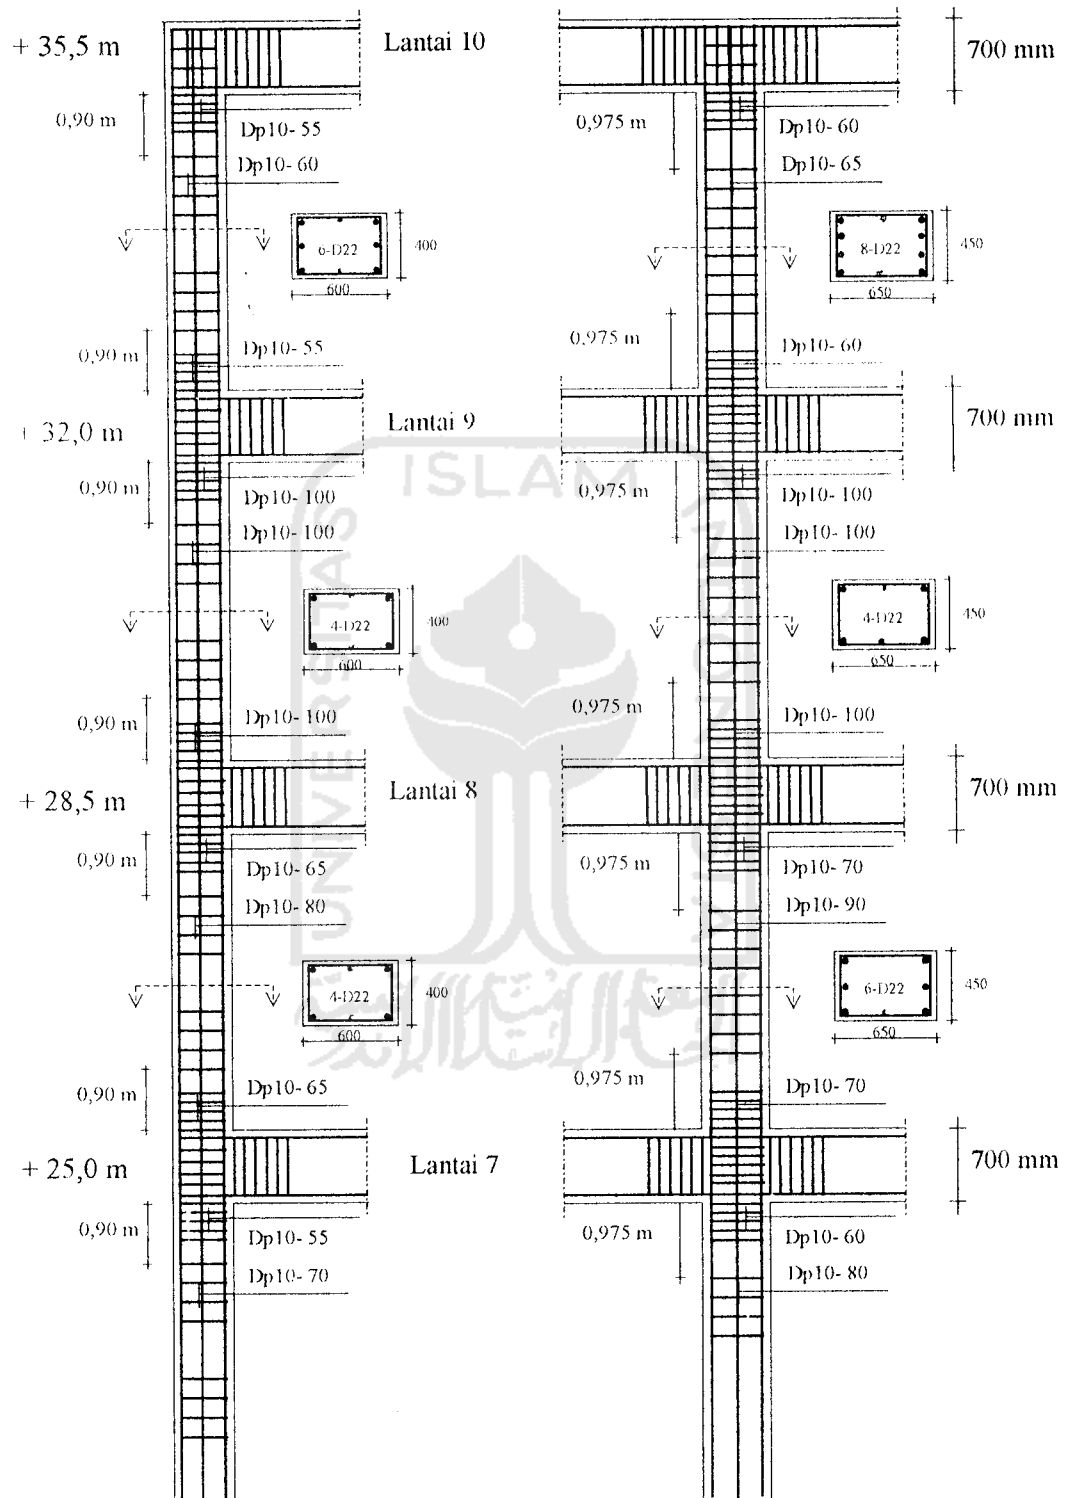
Detail Tulangan Balok Lantai 6 dan 10
